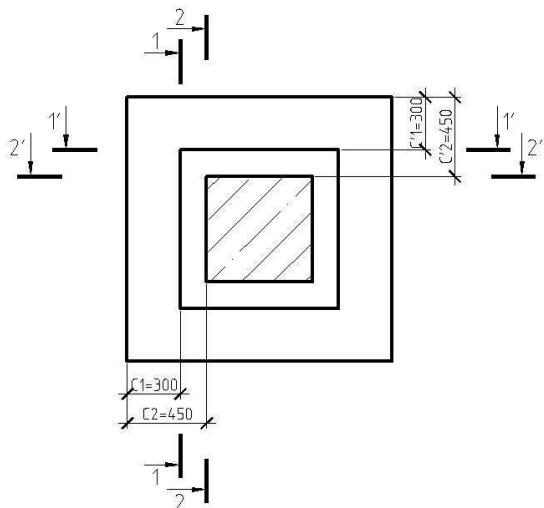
Схема к расчету арматуры плитной части фундамента
